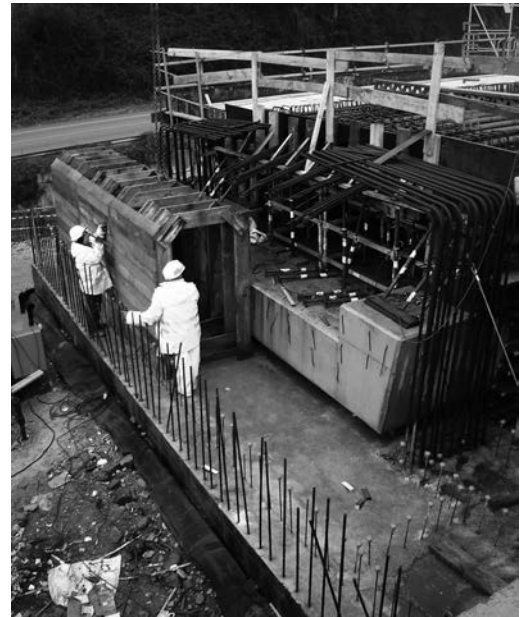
b. Ejecución de estribo, con galería para inspección de apoyos inversos.
